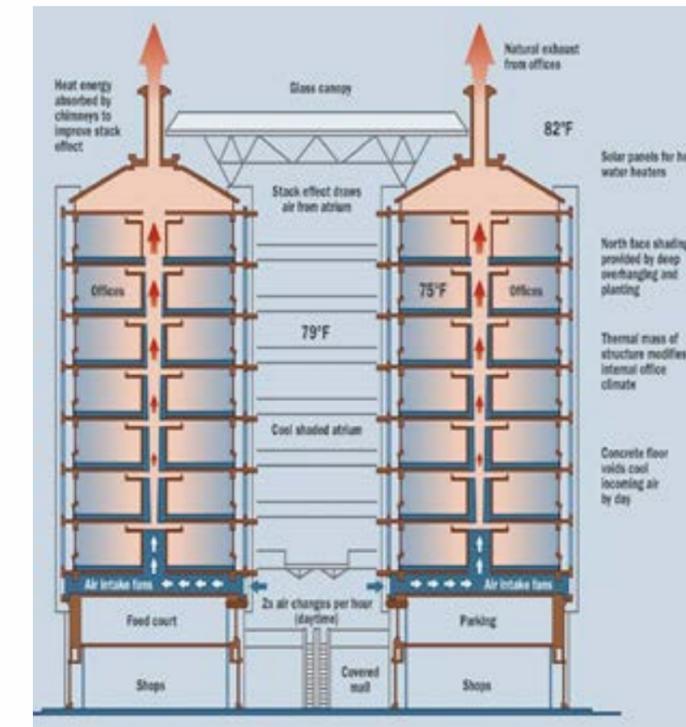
Sist. de ventilación de termitero aplicado a la arquitectura
